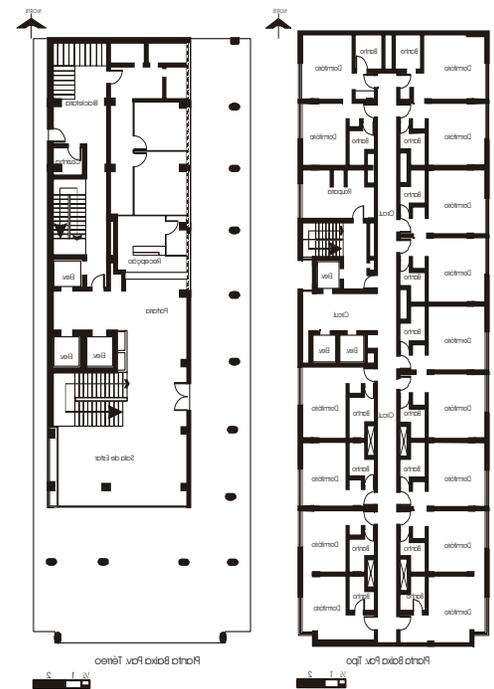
Hotel Charrua. Plantas baixas pavimento térreo e tipo.
